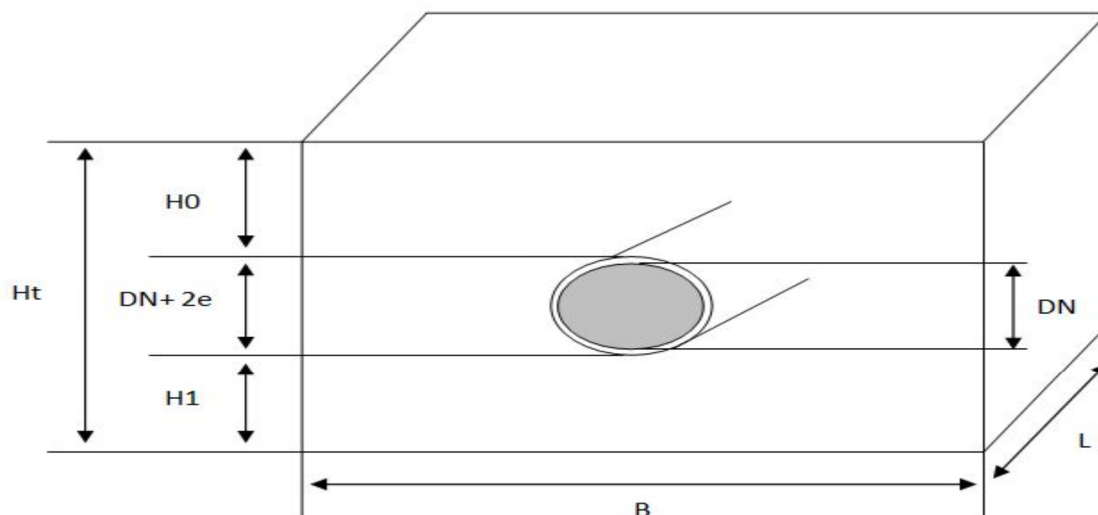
coup de perspective d'une fouille avec conduit.
